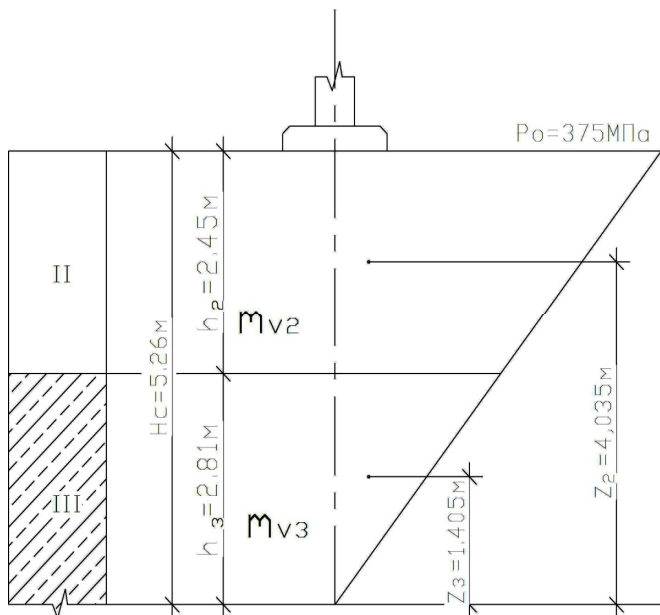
Расчётная схема осадки фундамента методом эквивалентного слоя
